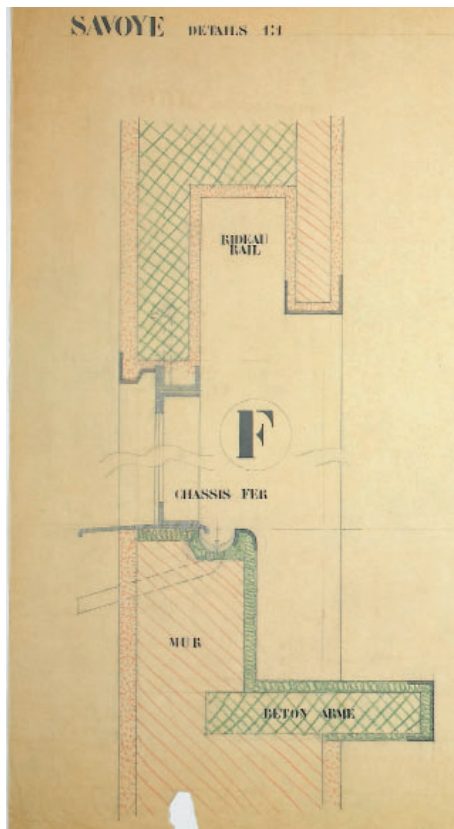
Sección "F" del plano de detalles de la *Villa Savoye* a escala 1:1, Atelier LC-PJ, 13-5-1929. FLC 19452 (pormenor 2).
